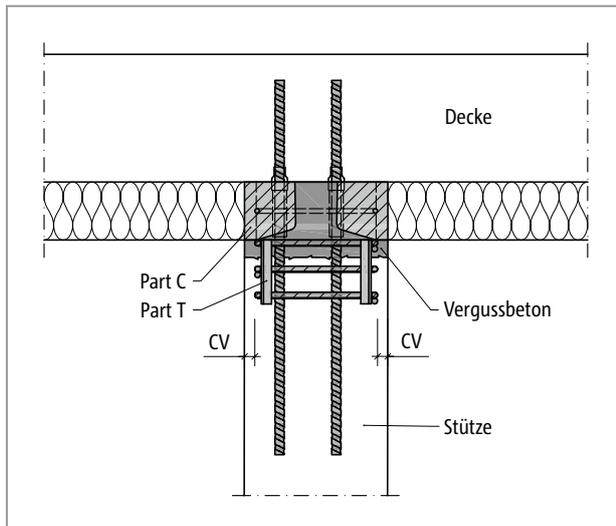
Schöck Sconnex® Typ P: Einbauschritt; Anschluss Stütze – Decke mit Part C und Part T
